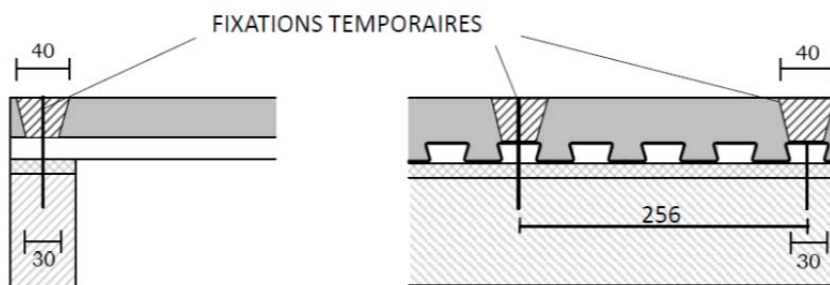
Plancher LEWIS de type 1 avec fixations temporaires
